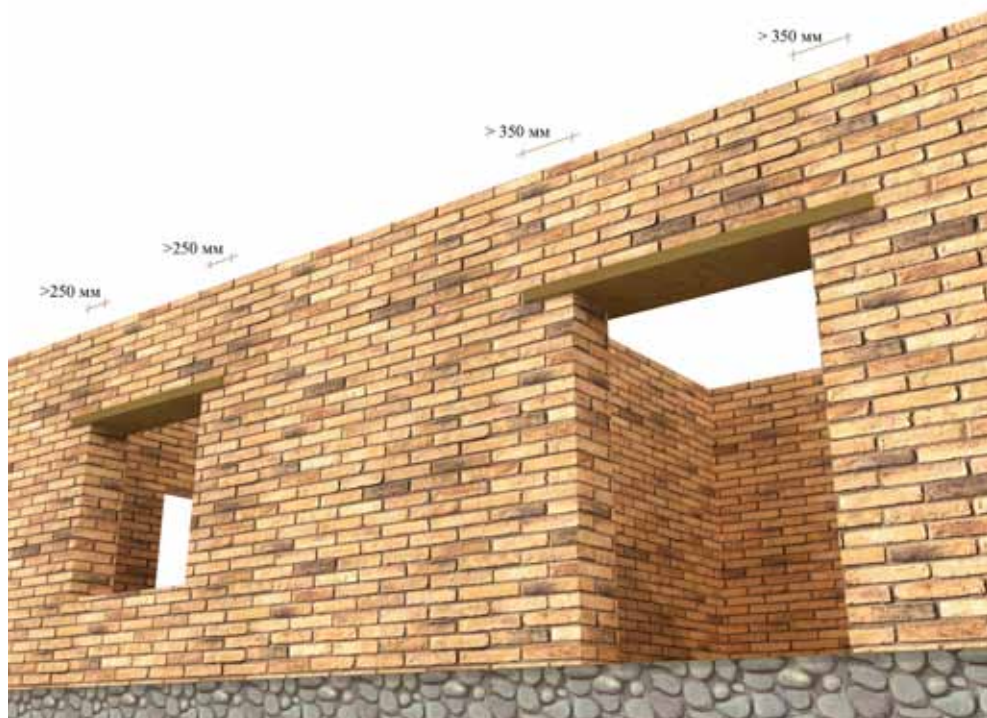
Опираие перемычек над оконными и дверными проемами
